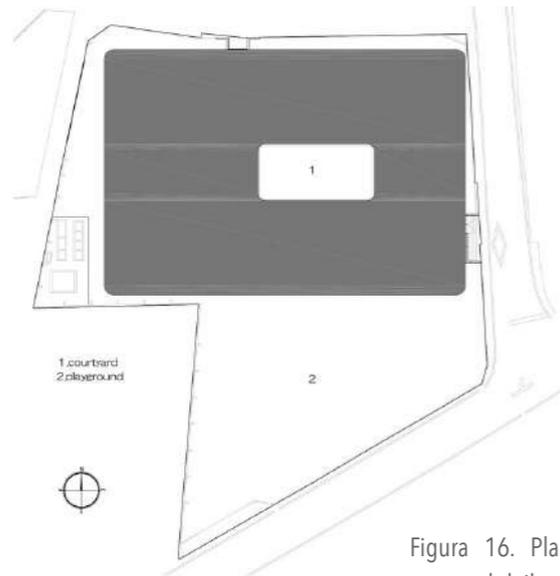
Planta entorno. Fuente: <https://www.archdaily.com>
